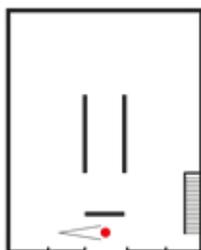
Totem informativo - primeiro pavimento. Fonte: Autor, 2020. Figura 105. Esquema do primeiro pavimento com marcação da visada. Fonte: Autor, 2021.
